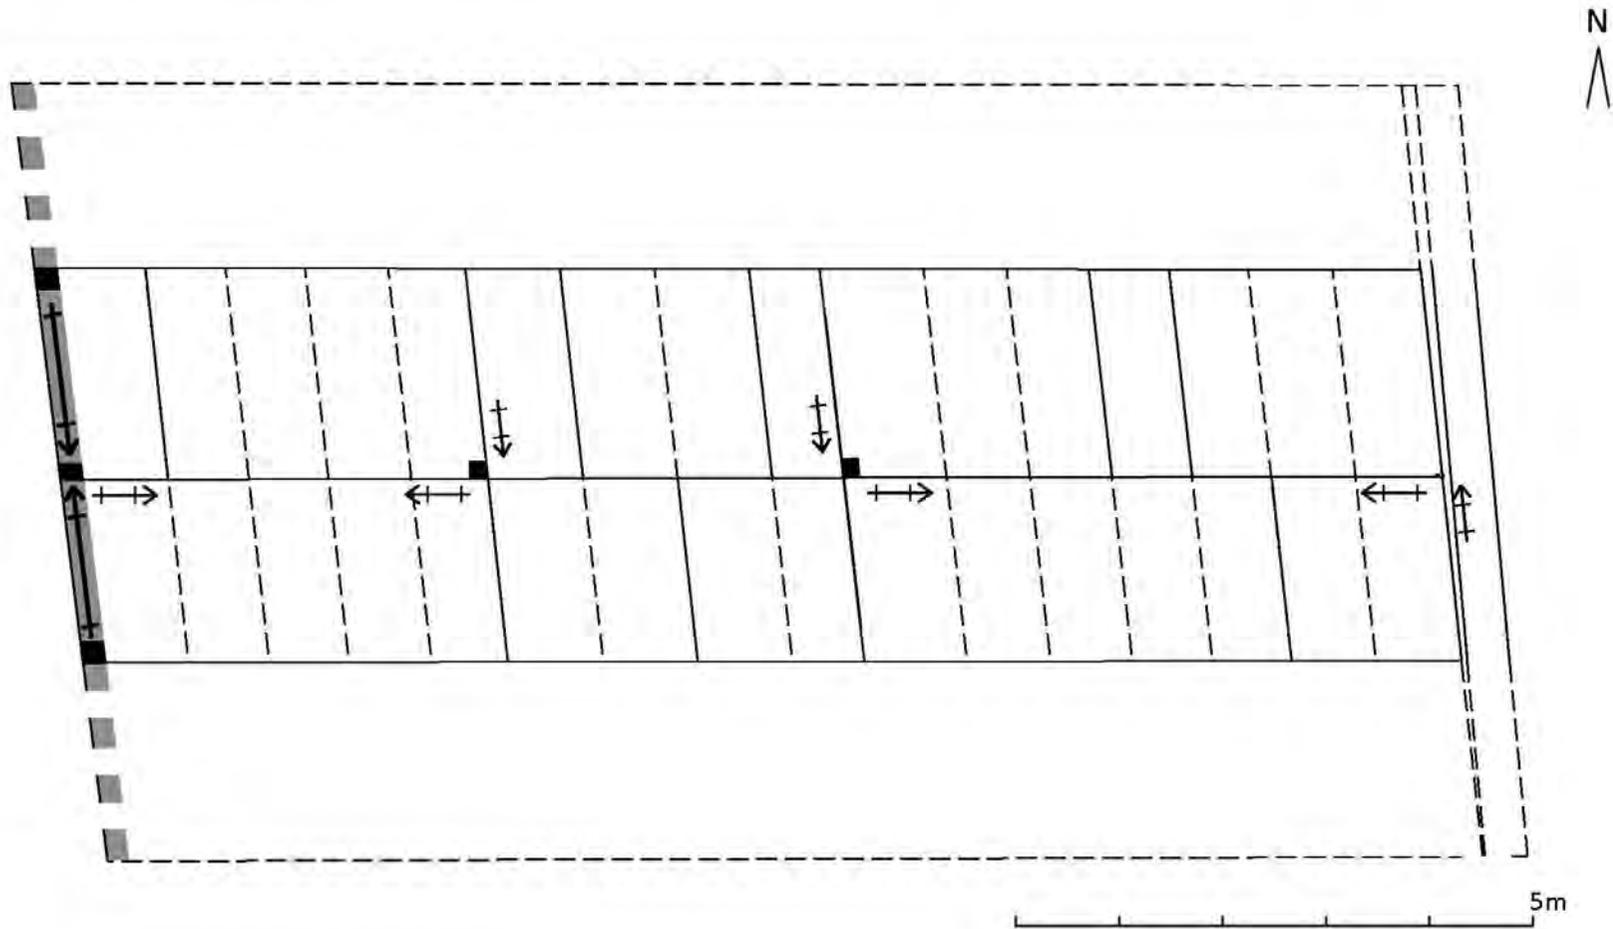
Freiburg, Markgrafenstraße 16a, sog. Melanchthonscheune, Systemgrundriss 2. Dachgeschoss
